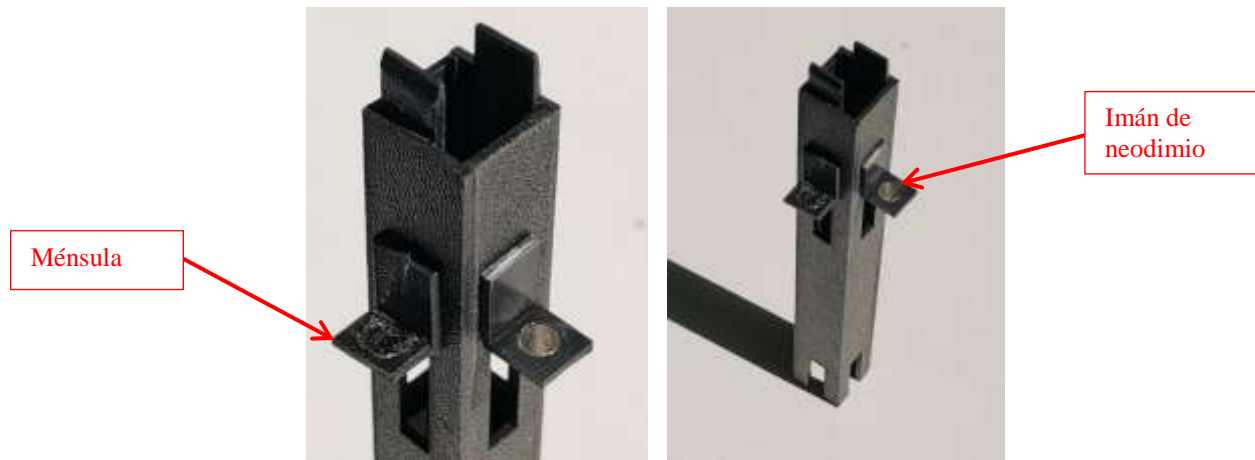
Detalle de ménsula con inserto de imán de neodimio para fijación de las vigas en la maqueta.
